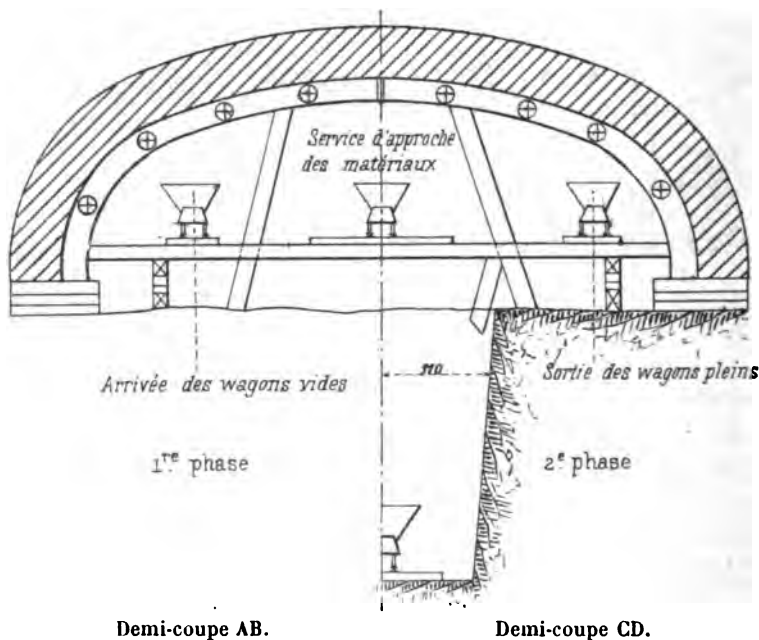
Plan du chantier, 1^{er} bouclier (Reuilly).
